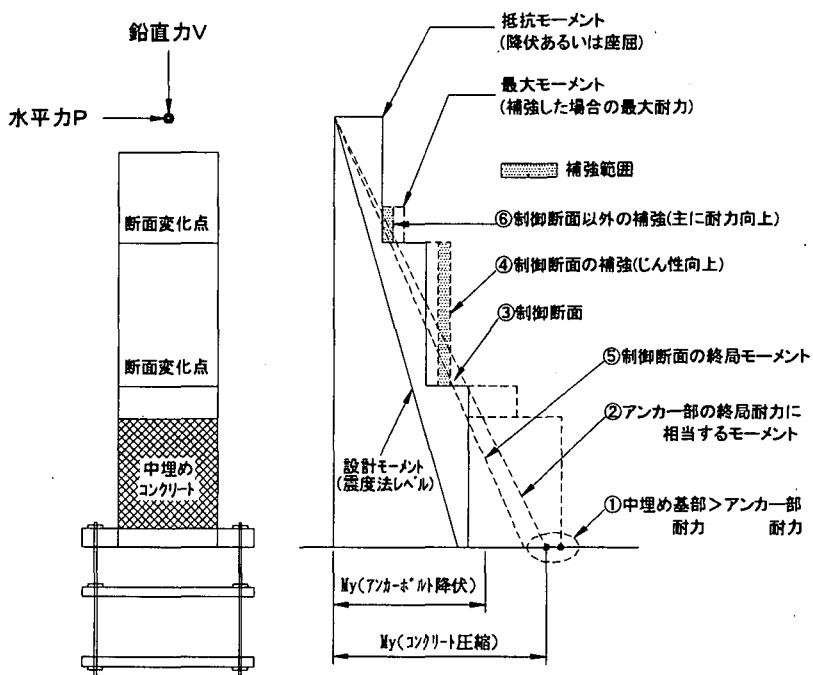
補強設計概念図（鋼断面の断面変化部を制御断面とする場合）
